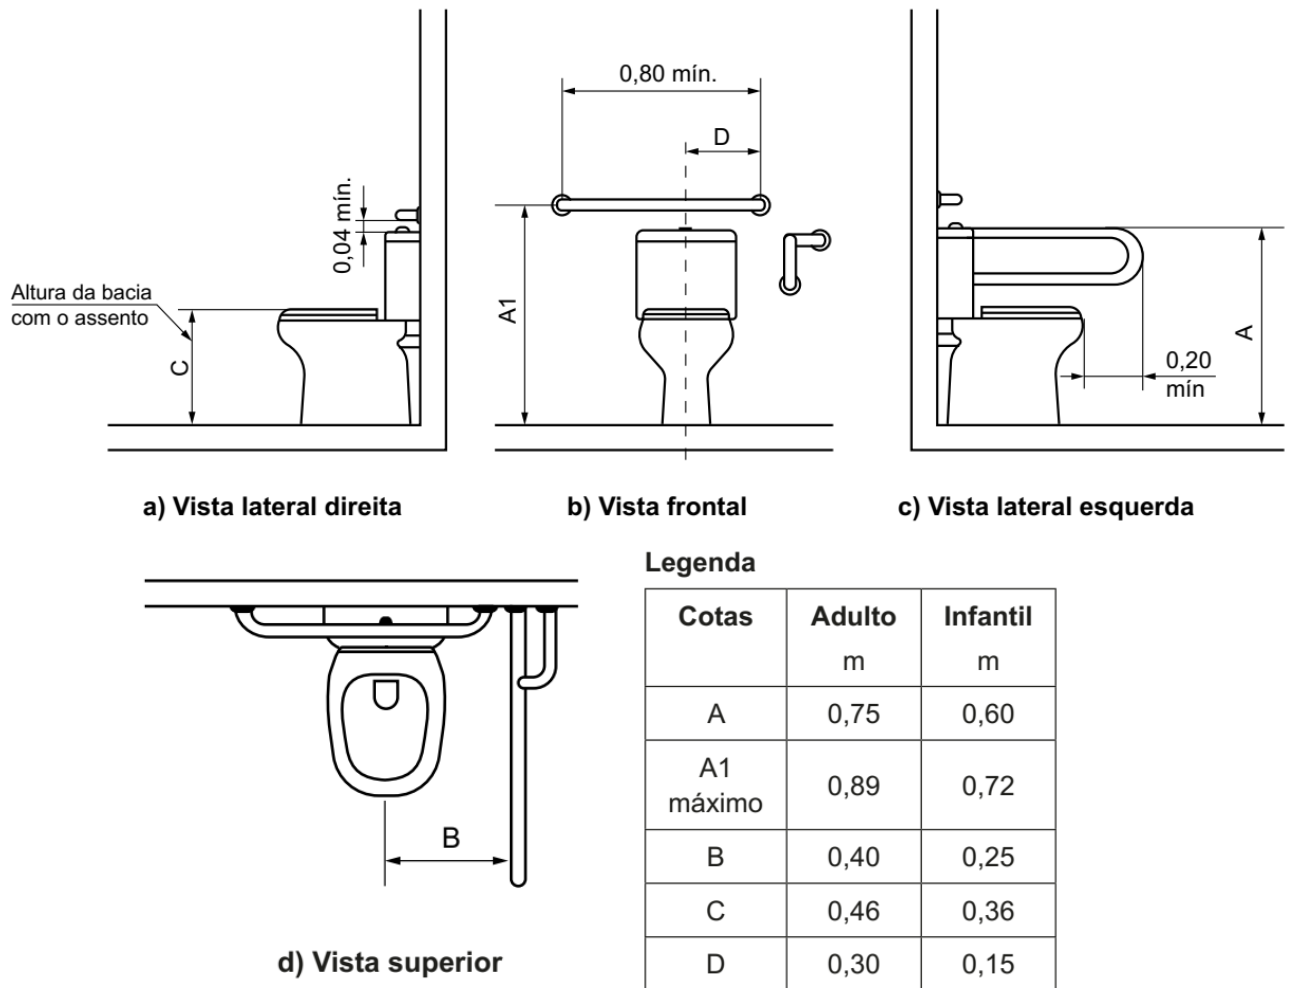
Instalação de barras de apoio na bacia sanitária, nos banheiros do hall do segundo pavimento – Fonte: NBR 9050
